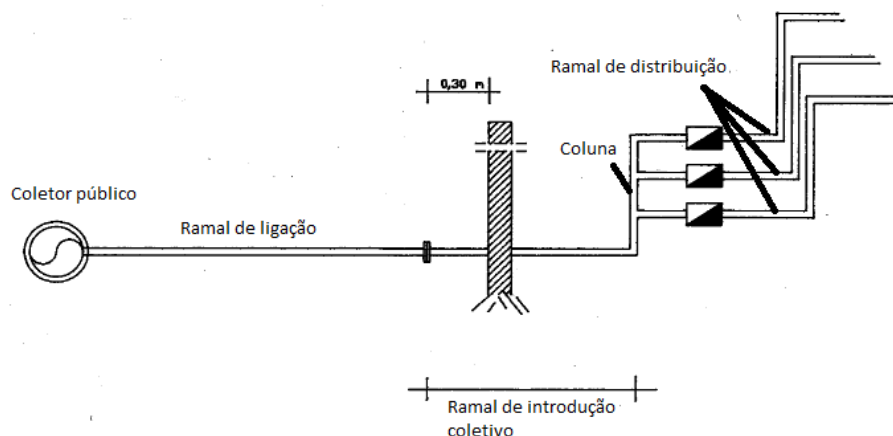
Ramal de introdução coletivo. Adaptado [3].
